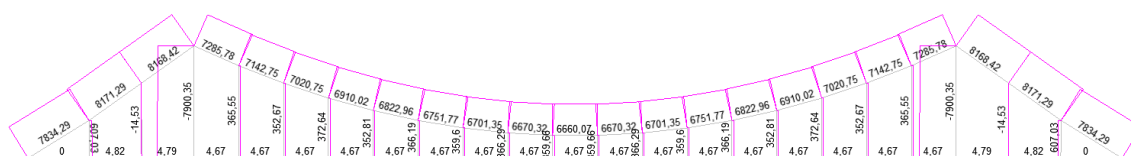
Эпюра усилий N от расчетной нагрузки (кН)
